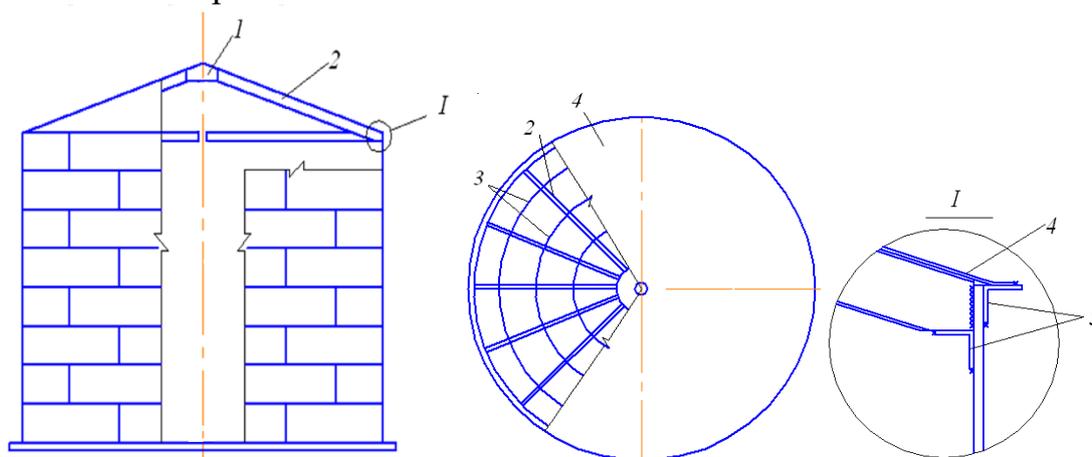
Конструкция РВС с конической крышей [178, с.56]: 1 – центральный щит; 2 – главные балки; 3 – кольцевые балки настила; 4 – настил; 5 – опорные кольца жесткости
